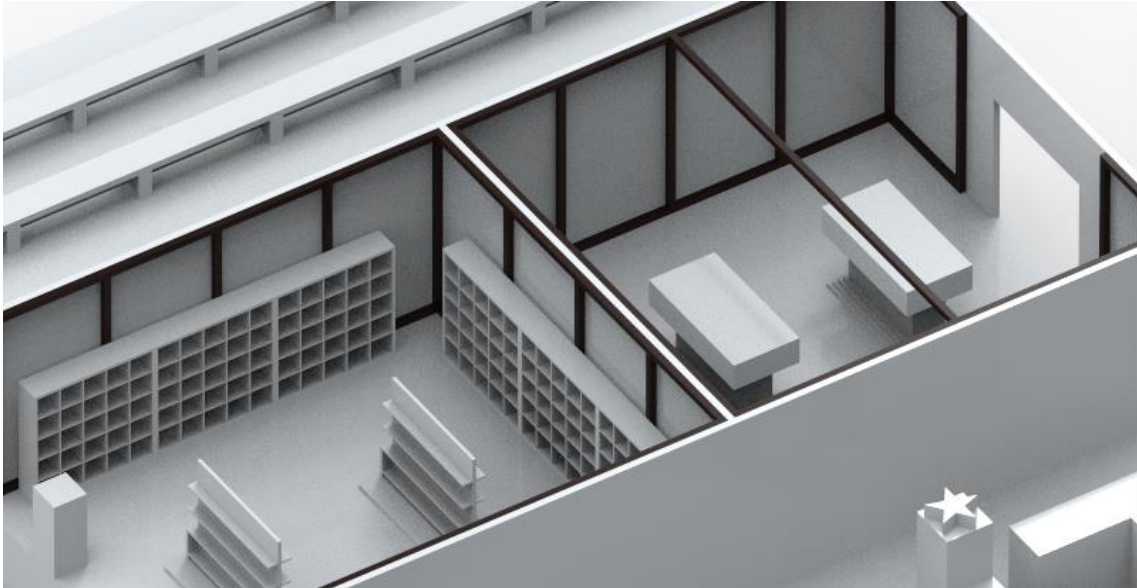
Vista en perspectiva en 3D de estructura interna de vigas (fuente propia)
